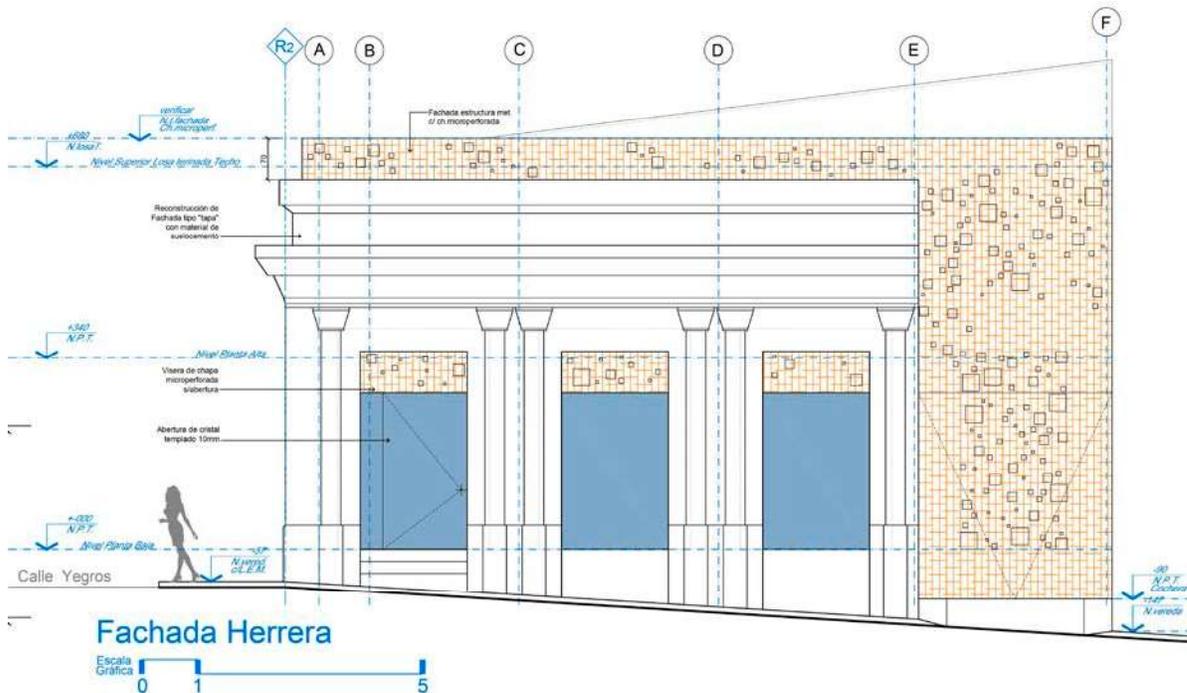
La fachada reconstruida con suelo cemento sobre la Calle Herrera. La caja de la nueva arquitectura detrás
